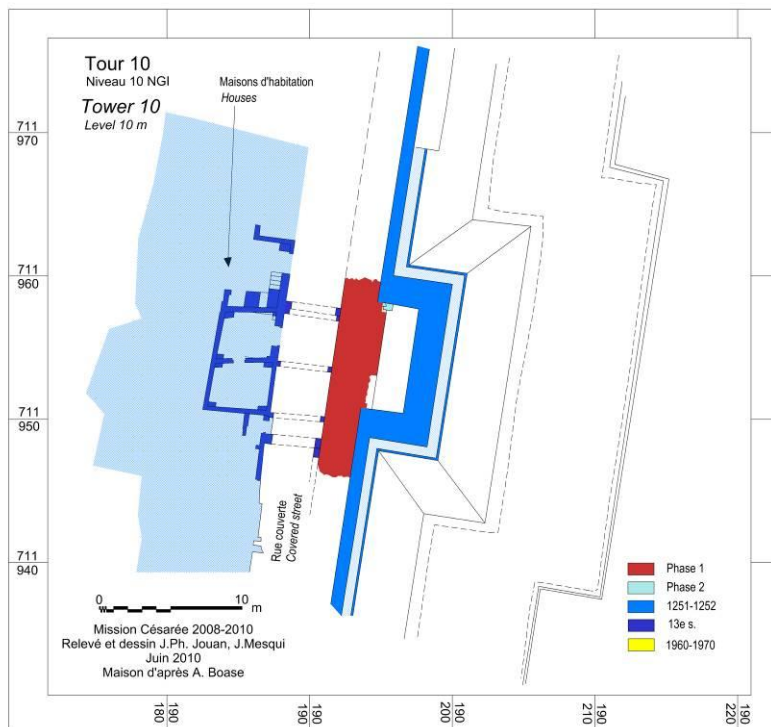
Plan de la tour T10 au niveau 10 m ASL
